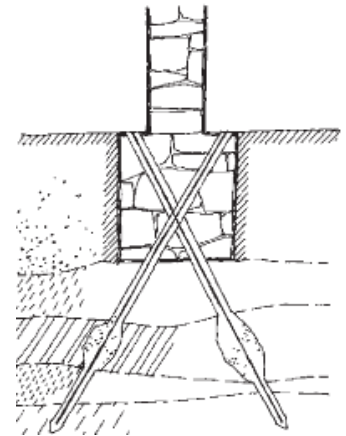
consolidation d'une fondation en sous œuvre de BA
